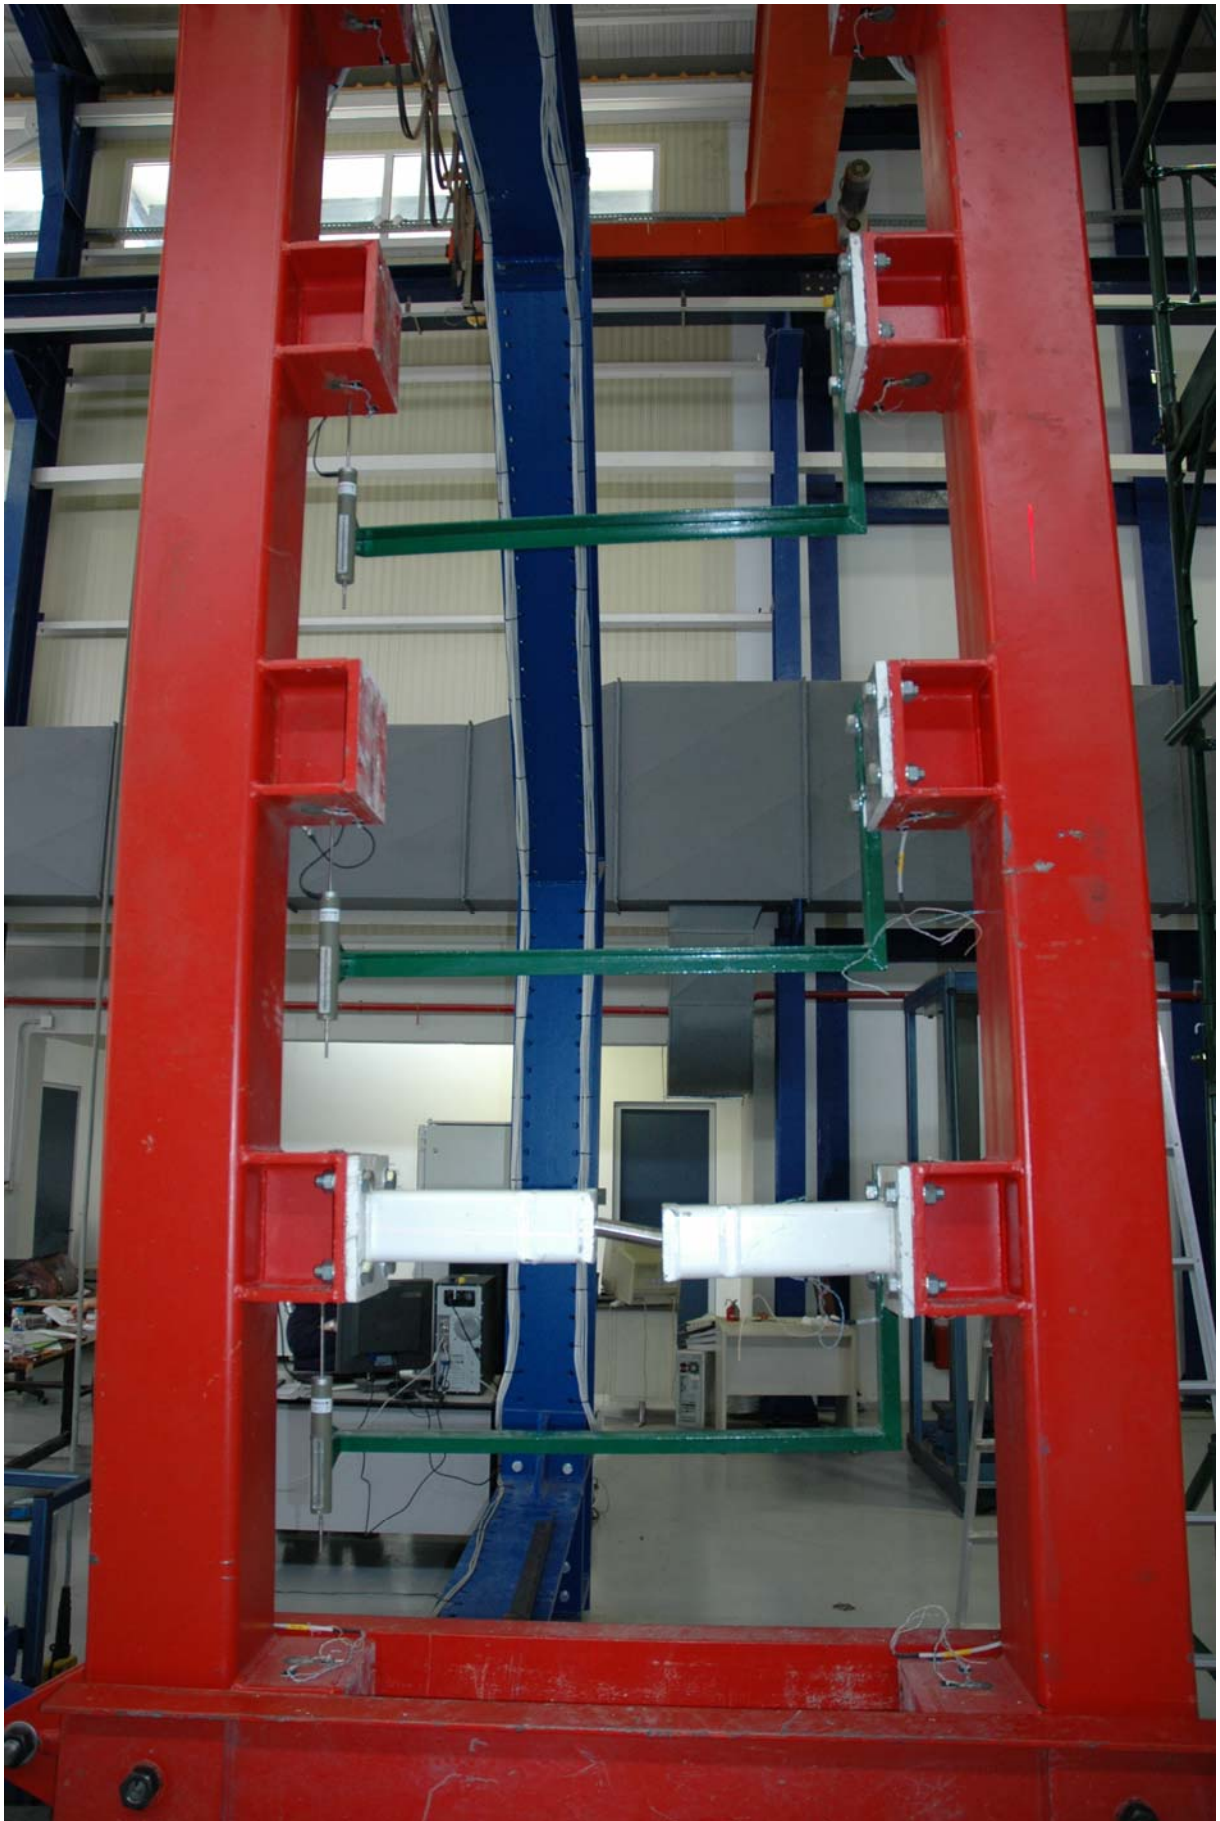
Τα δοκίμια του πειράματος 1 ROD double screw
